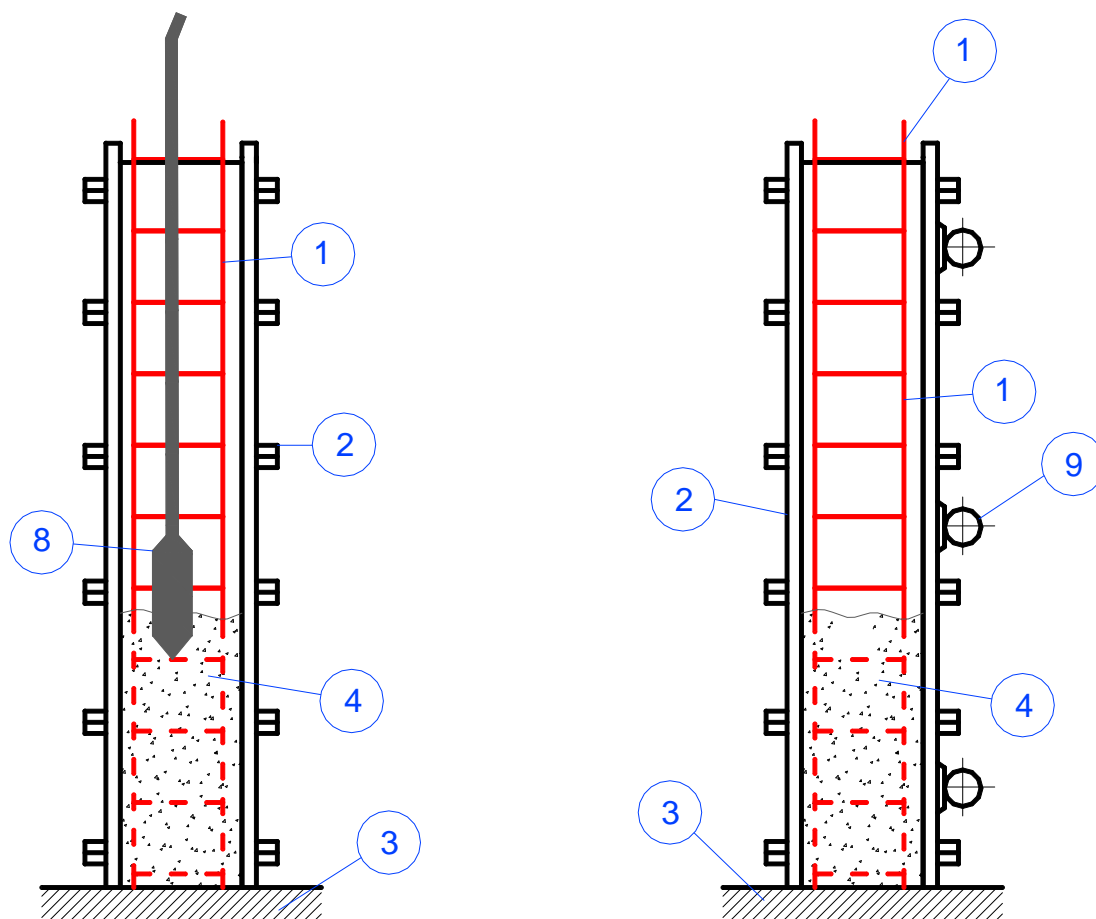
Варианты уплотнения бетонной смеси при укладке ее в конструкцию стен
